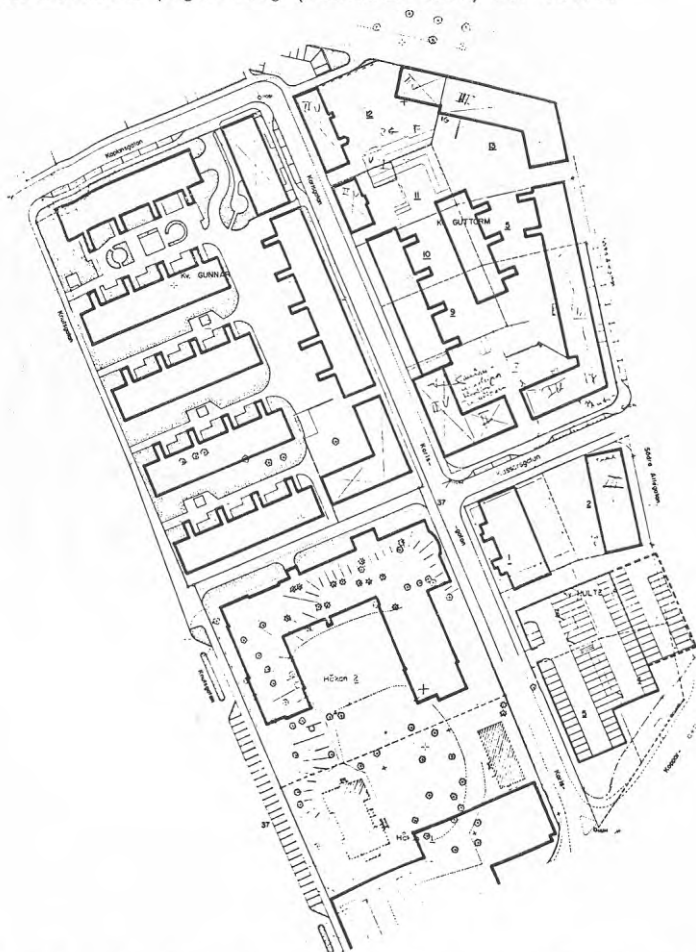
Planskiss för kv. Gunnar under genomförande. 1977.
